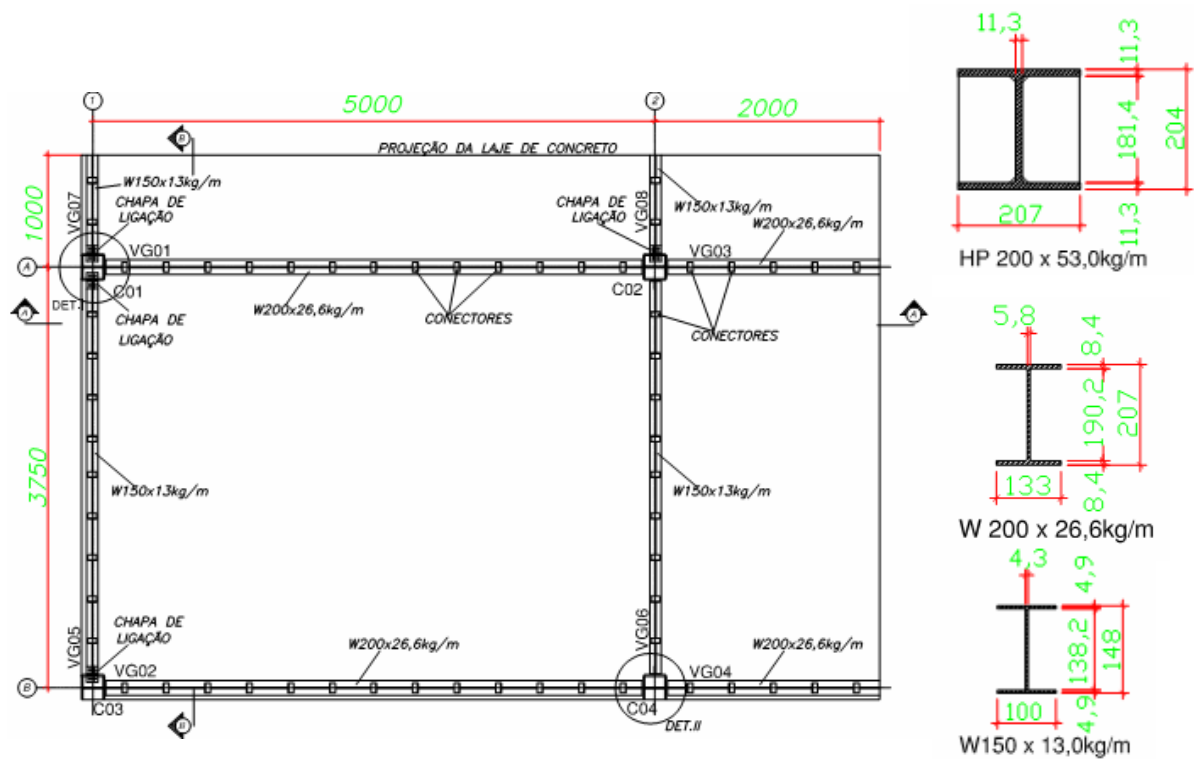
Planta do pavimento tipo ensaiado e seções das vigas e pilares
